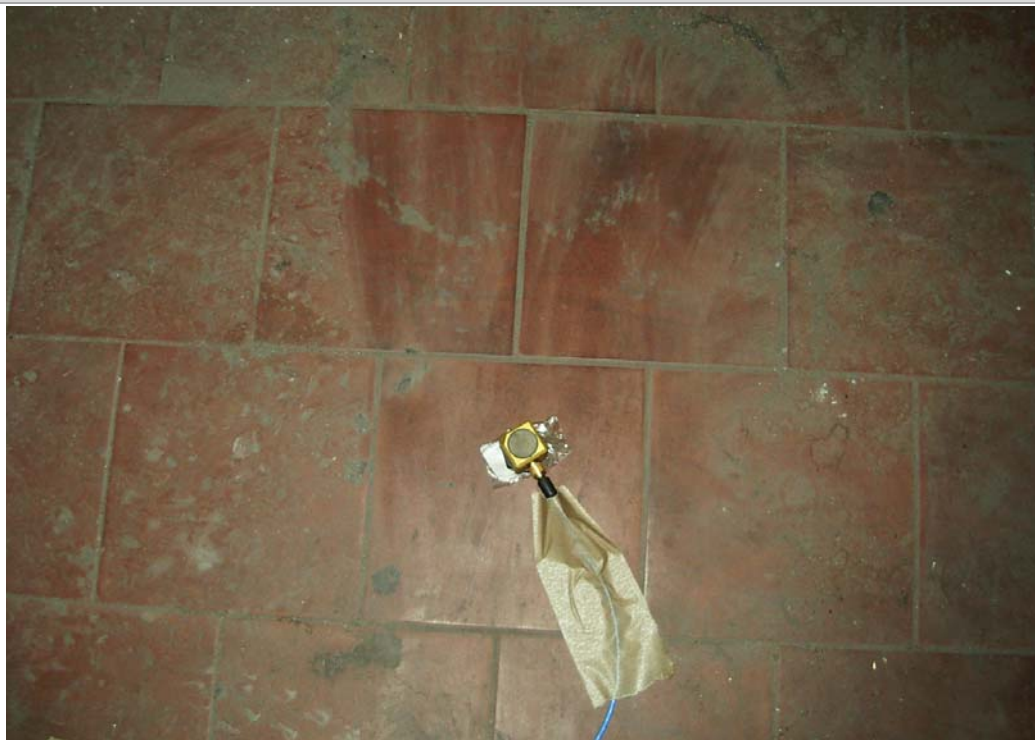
Ripresa fotografica della postazione di misura al centro della stanza al piano alto
